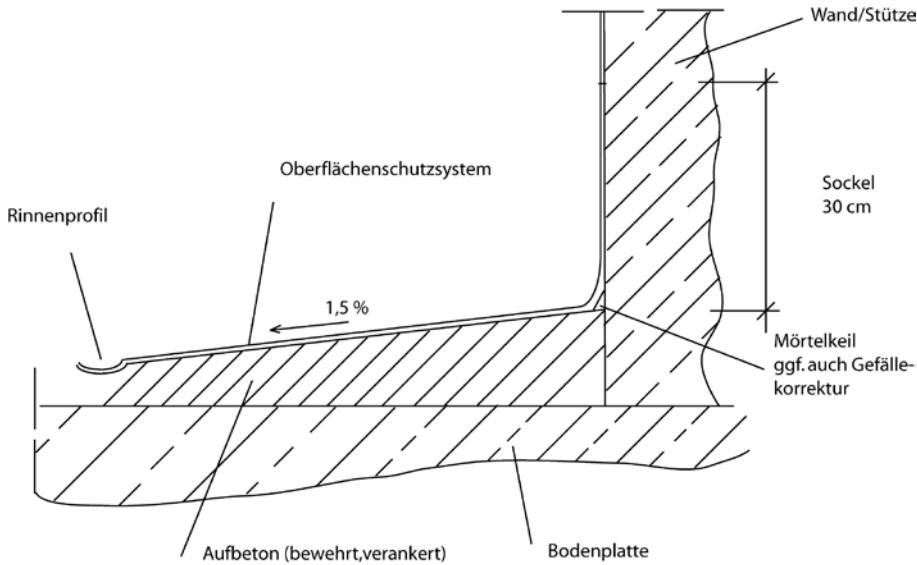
Variante 3 »Instandsetzung mit Aufbeton und Oberflächenschutzsystem«
